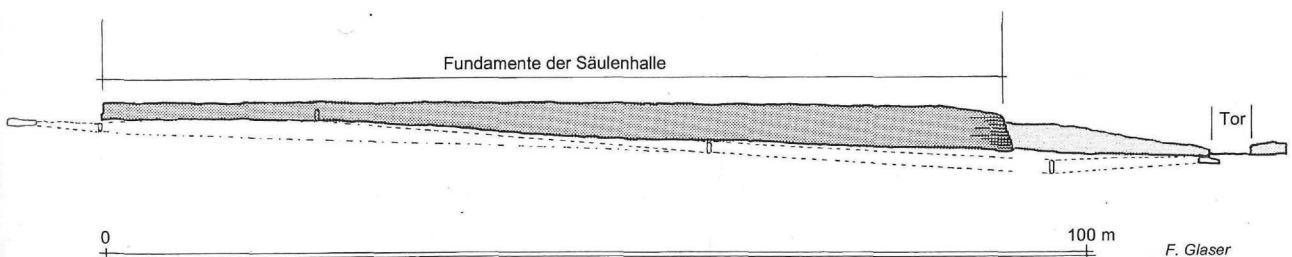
Nordansicht des Fundamentes der Säulenhalle, Torbau und ansteigende Rampenmauer (= strichliert)
